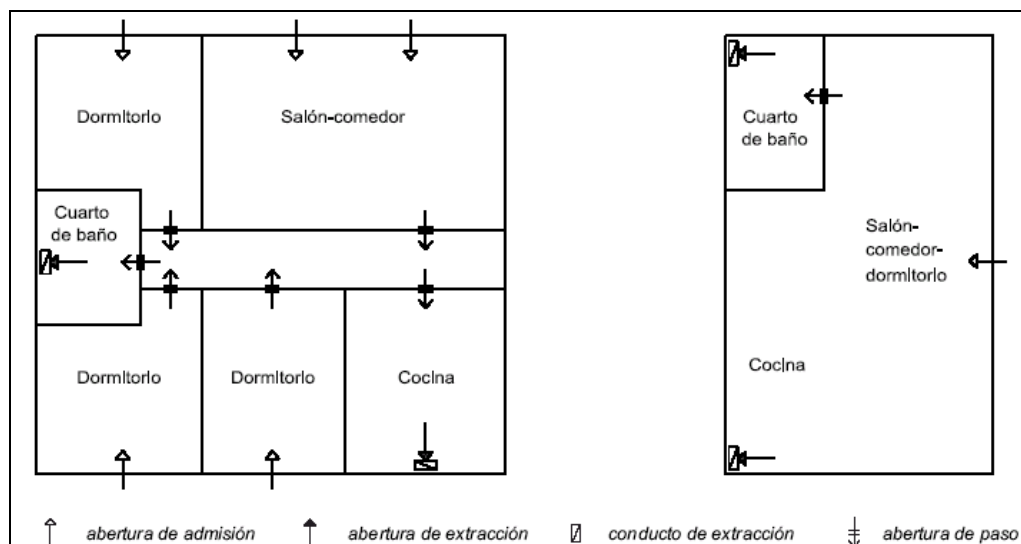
Ejemplos de ventilación en el interior de las viviendas
